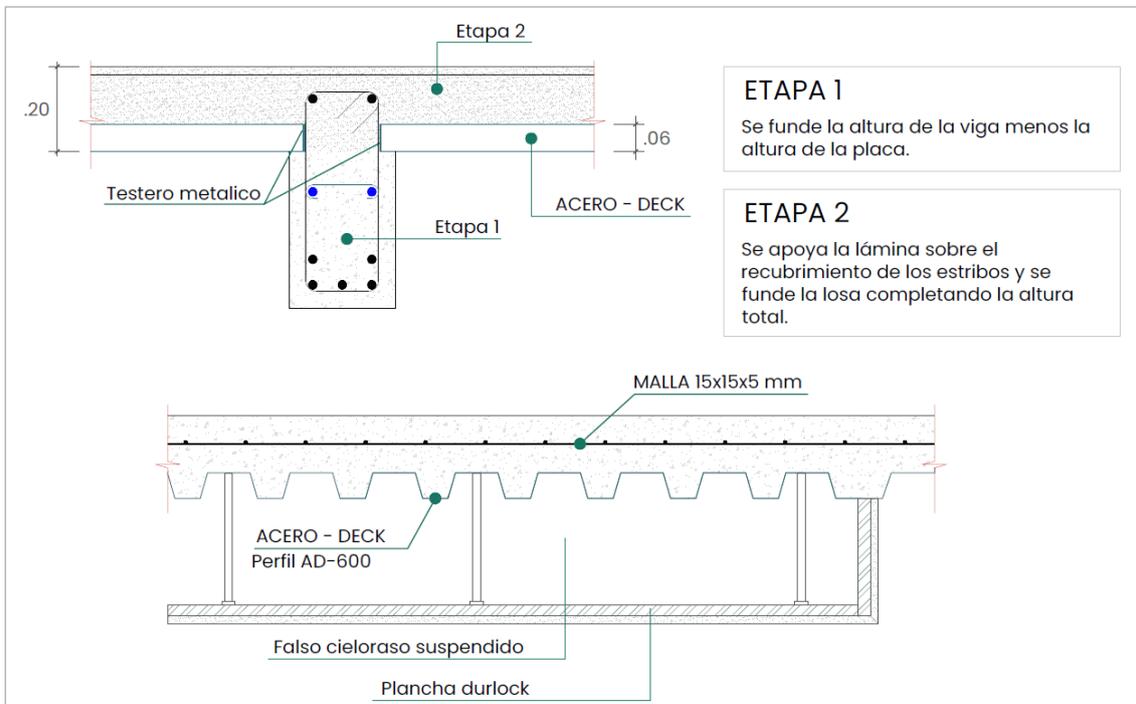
Losa Colaborante propuesta en Zona Educativa – Bloque C.
